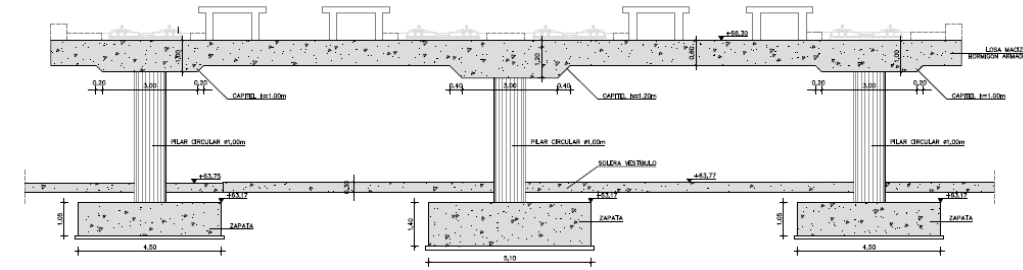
Sección transversal estructura de los andenes (fuente: PC estación Vecindario)
